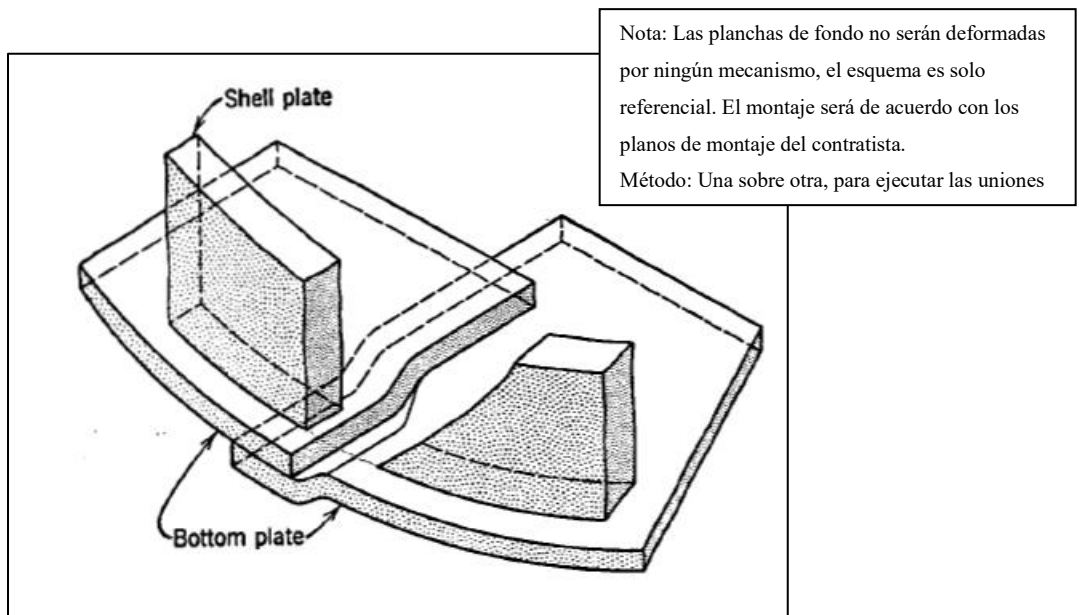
Esquema de Montaje Planchas de Fondo y Primer Anillo del Manto.
